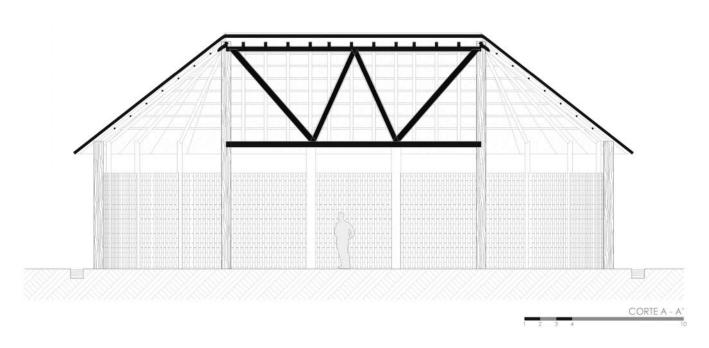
Planos arquitectónicos\_ Vivienda shuar Elaborado por: El autor
